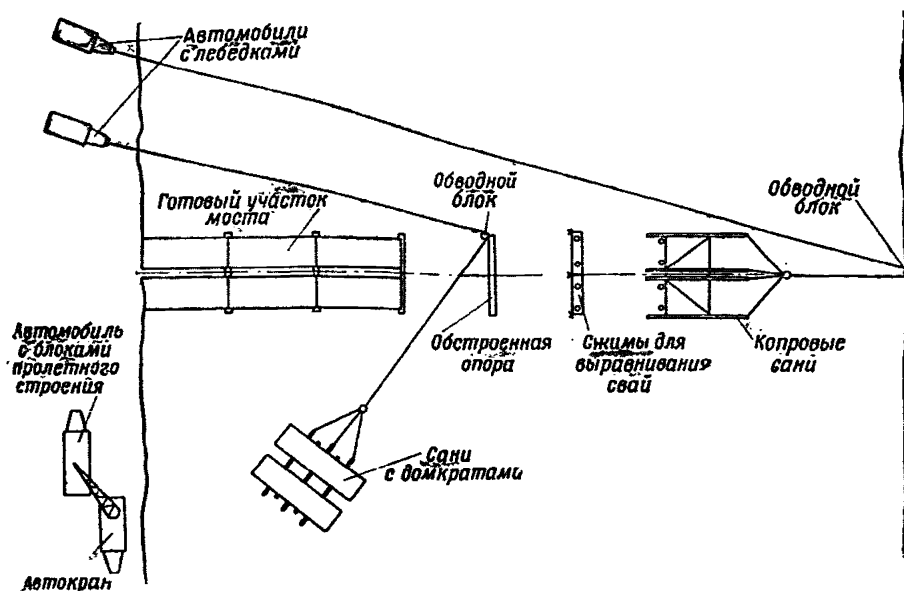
Схема организации работ при постройке зимнего моста с использованием саней с домкратами для укладки пролетного строения
